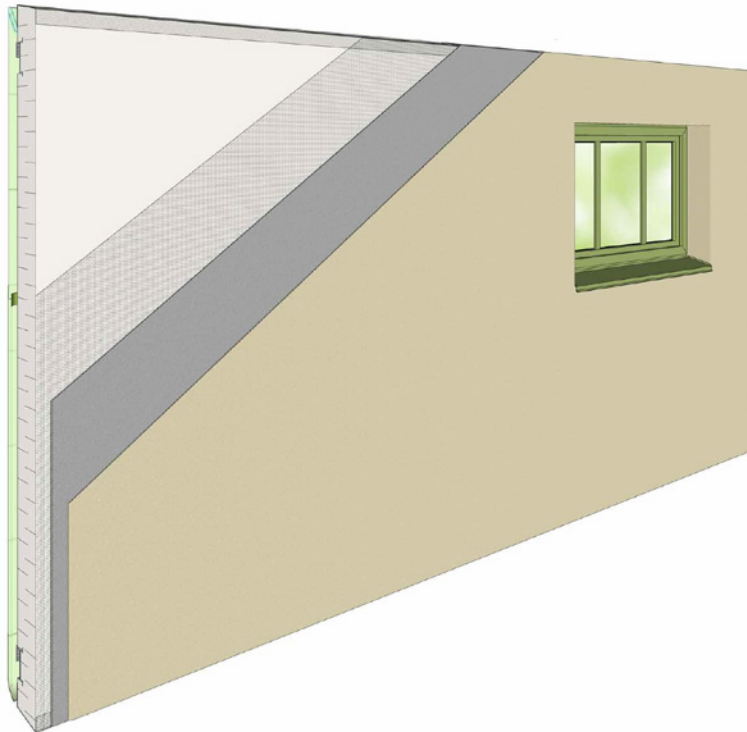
Aperçu des panneaux muraux SIFE de rénovation (les points verts indiquent les éléments de jointoiement et d'encastrement appliqués sur le site).
